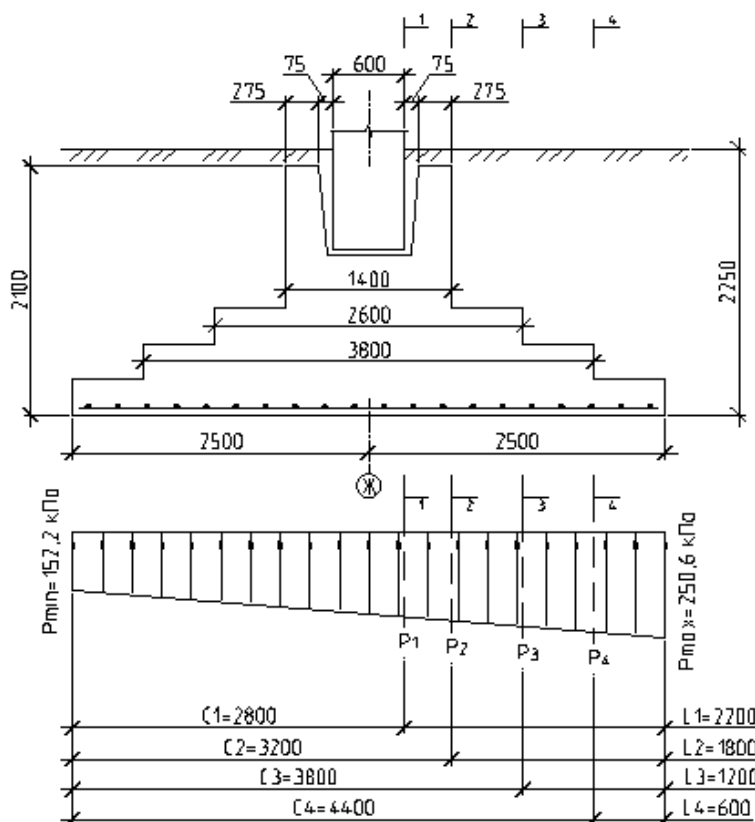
Епюри розподілу напружень під подошвою фундаменту
